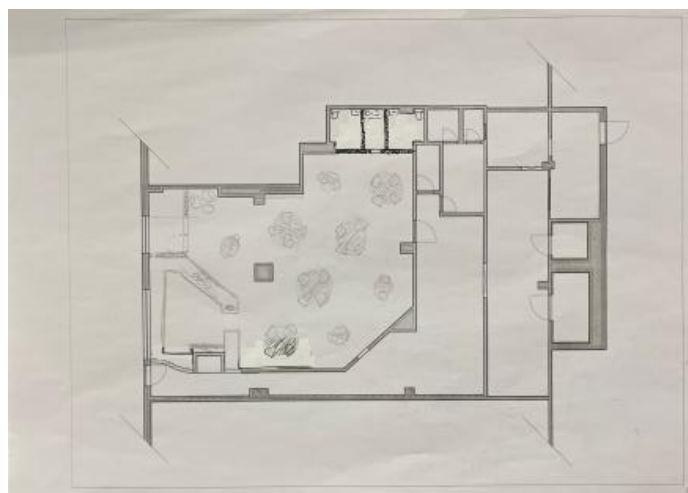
Planta de estudo 4. Fonte: Autora, 2025
